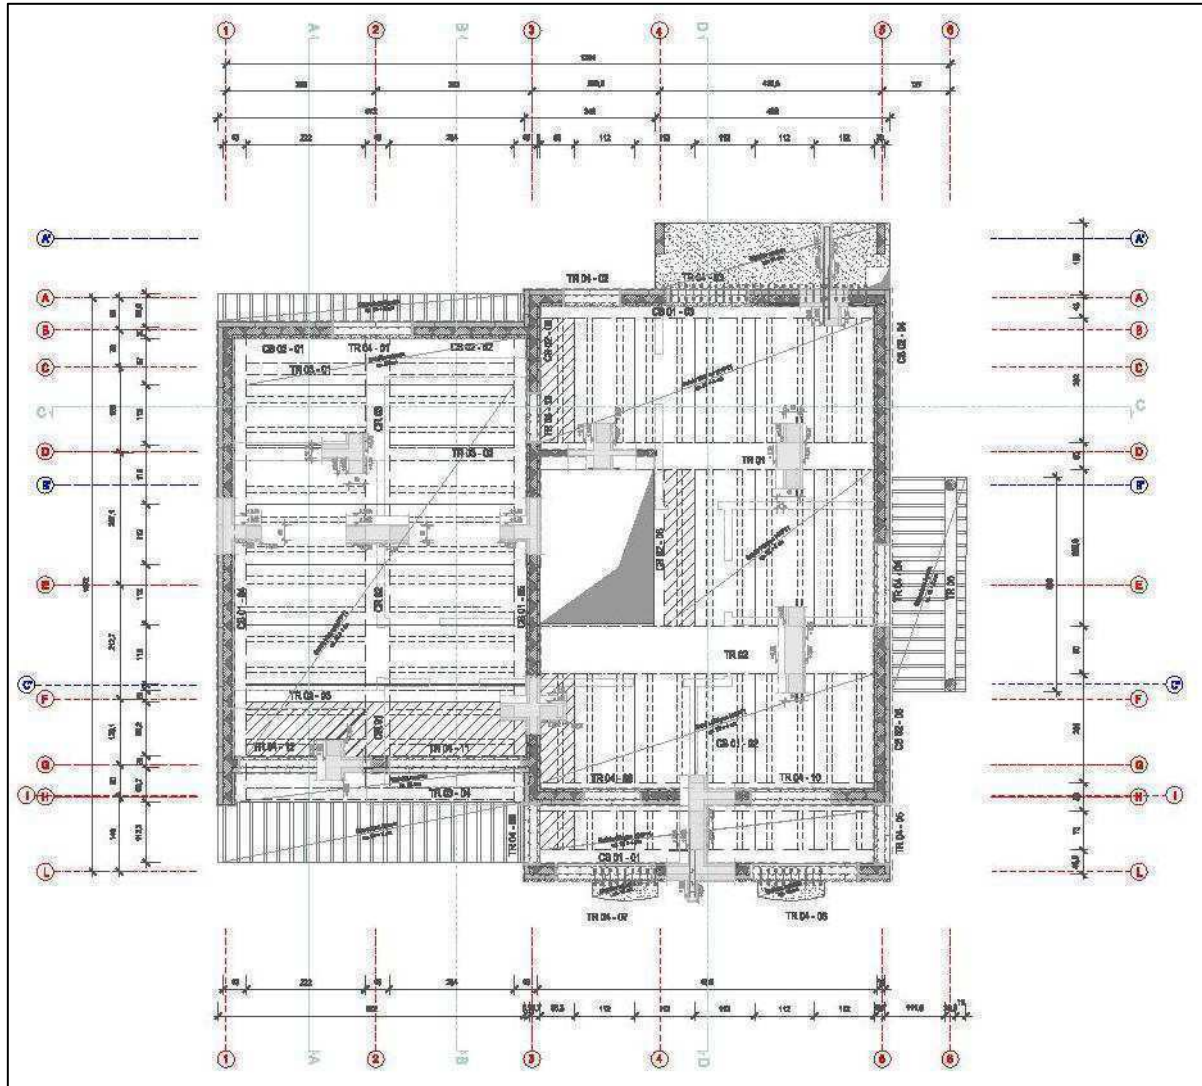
Pianta Piano Terra – Solai – Carpenterie; Tavola 4.
